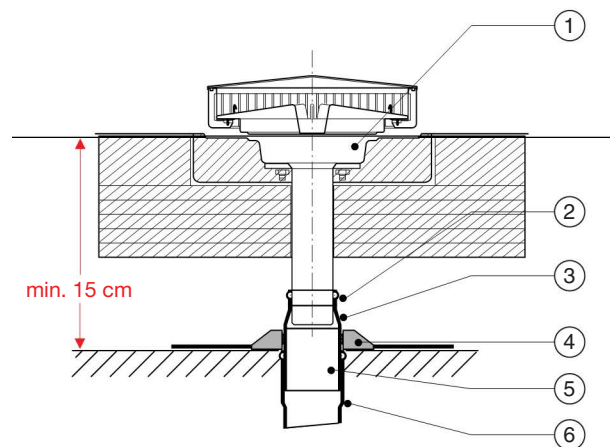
Übergang bestehendes – neues System bei Dachsanierung
